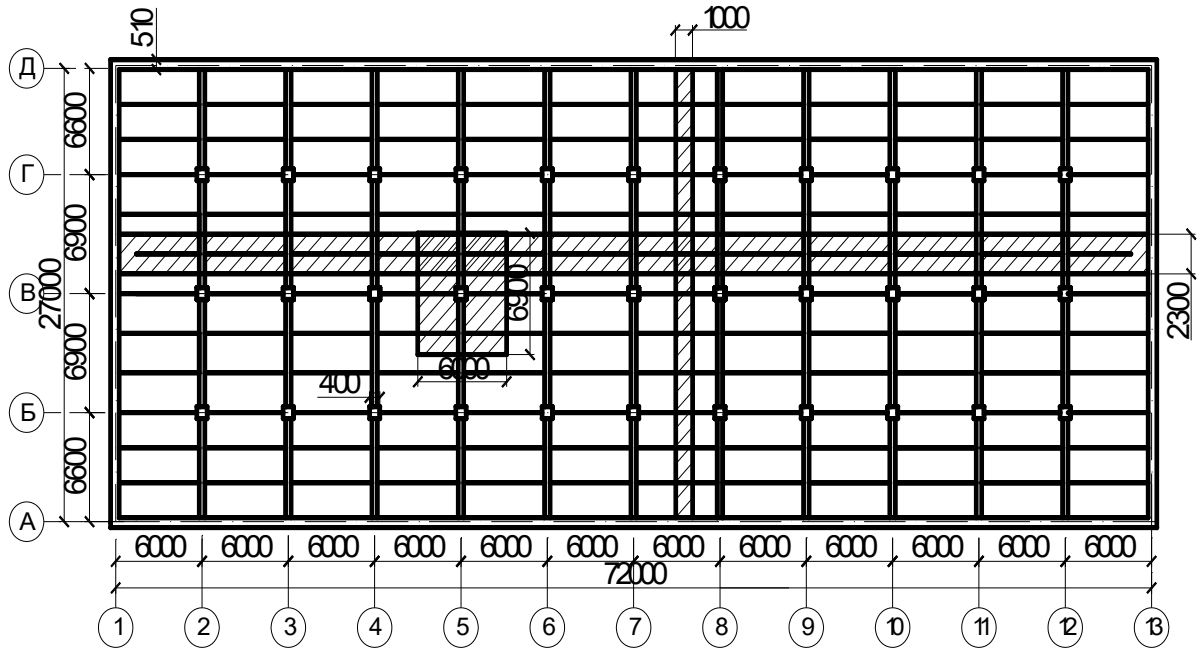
Схема монолитного междуэтажного перекрытия (вариант 1)
